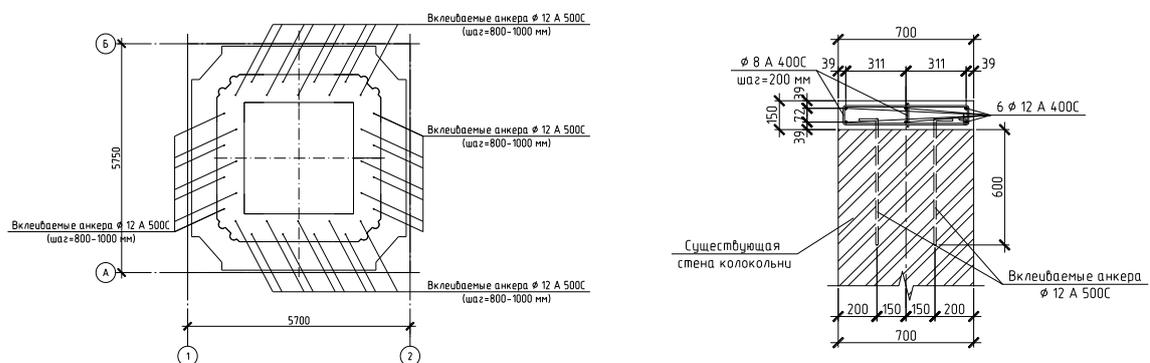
Схема усиления верхнего обреза стен колокольни Балаклавского Георгиевского монастыря устройством монолитного железобетонного антисейсмического пояса с клеиваемыми анкерами
